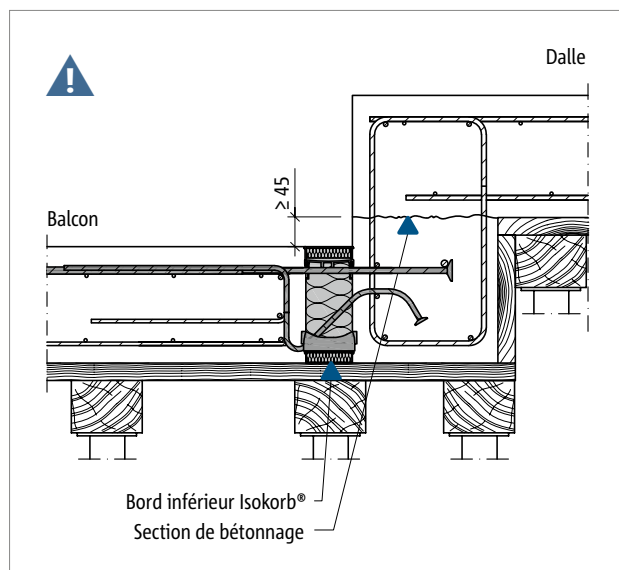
Schöck Isokorb® T type K-U : balcon en béton coulé sur site avec décalage vers le bas
